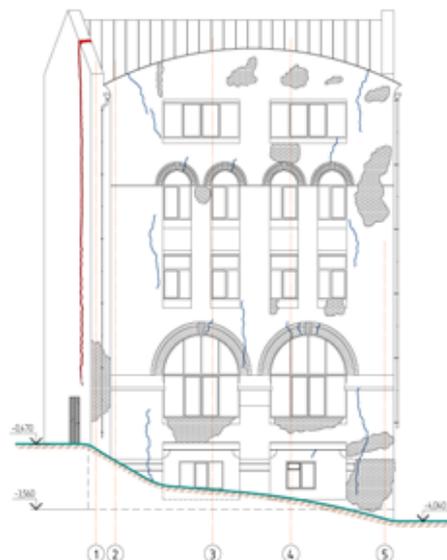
Схема расположения дефектов в стене главного фасада
